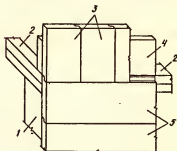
Схема сопряжения наружной обшивки 1-го и 2-го этажей:
